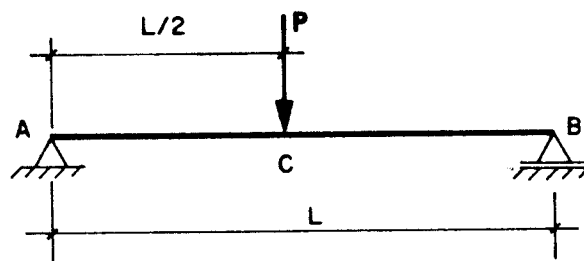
Viga simplesmente apoiada sujeita ao carregamento indicado pertencente a uma determinada estrutura de aço.
